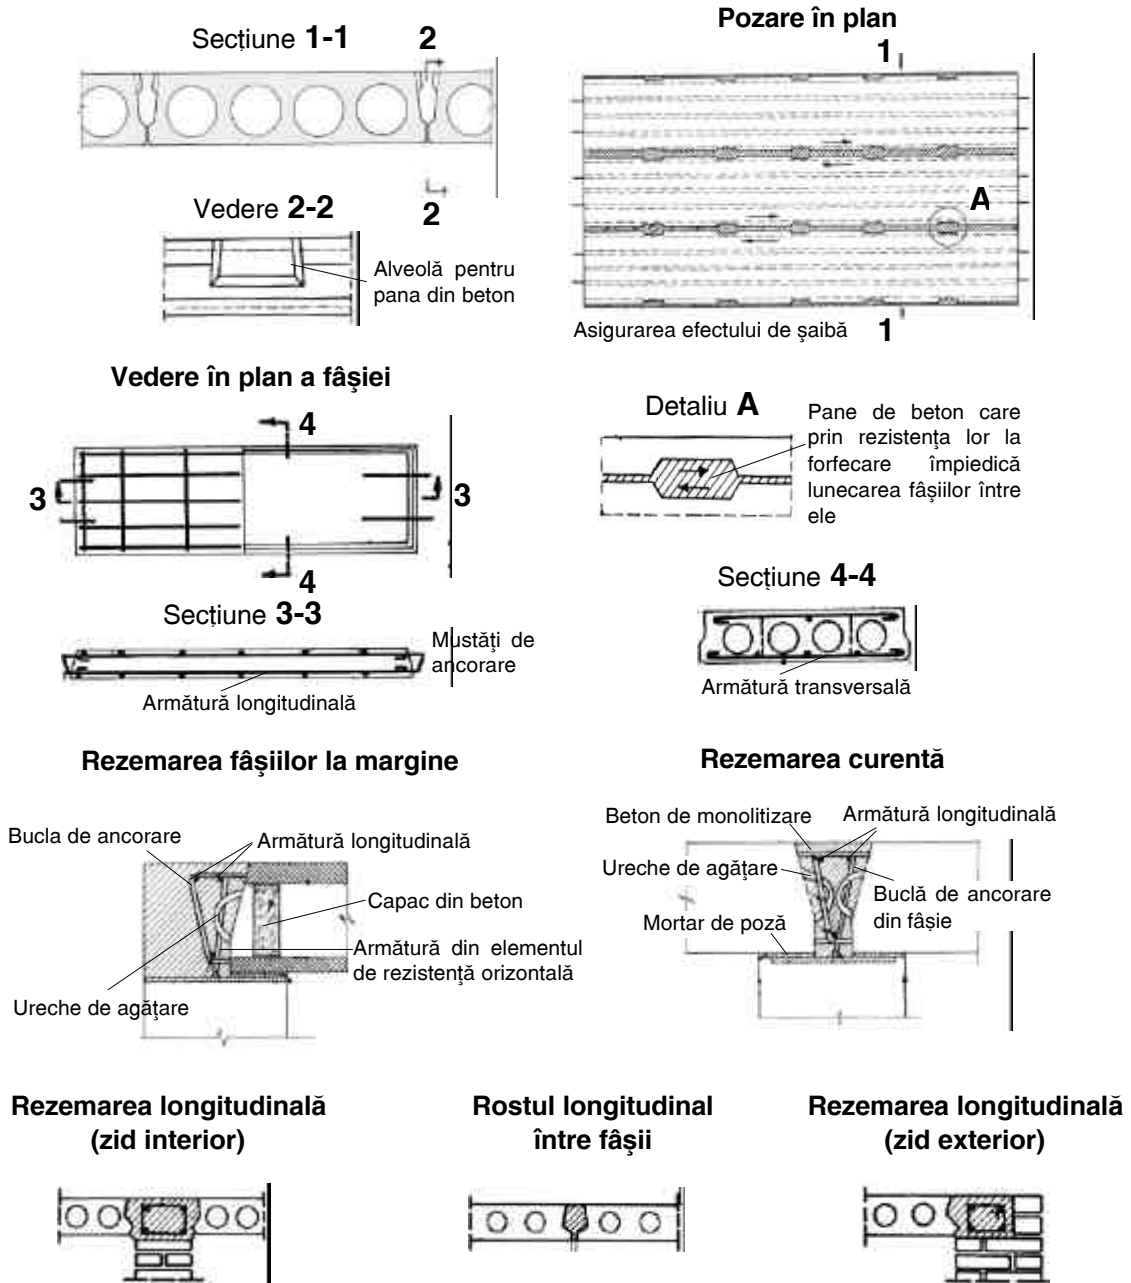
Planșee prefabricate din fâșii cu goluri din beton armat. Vedere în plan. Secțiuni. Detalii îmbinări
